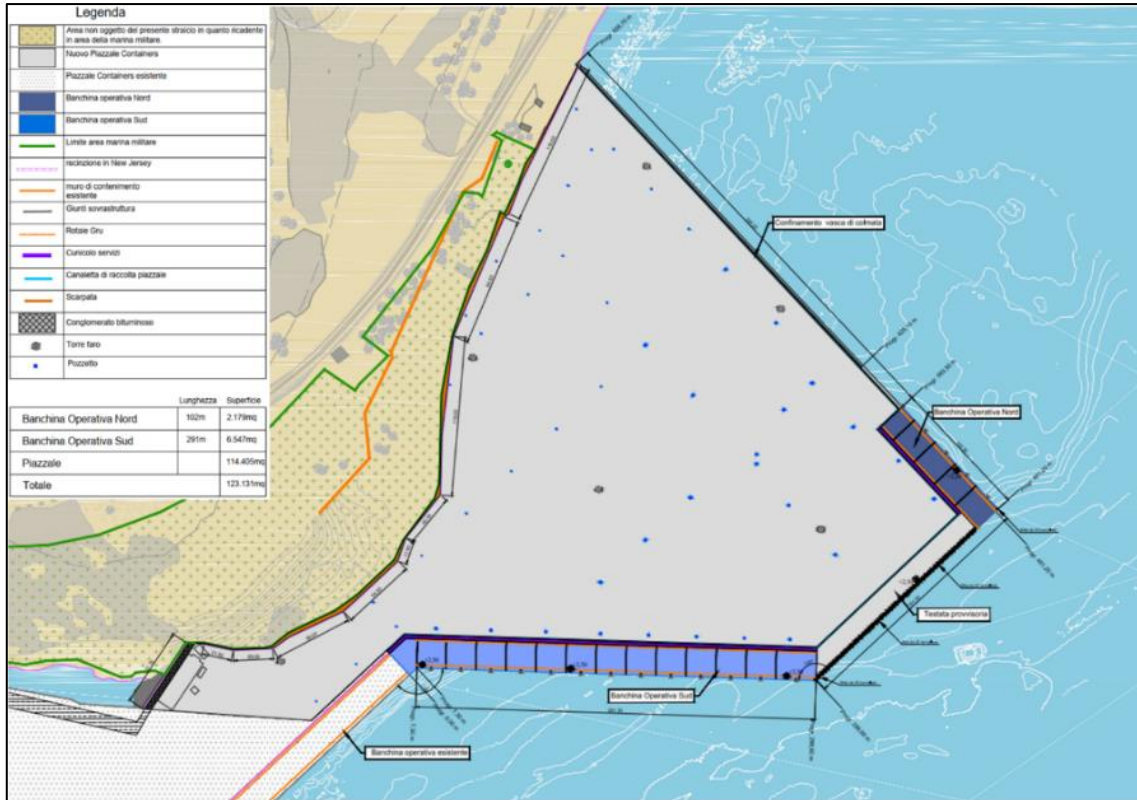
Porzione del New Terminal container preliminarmente individuata
